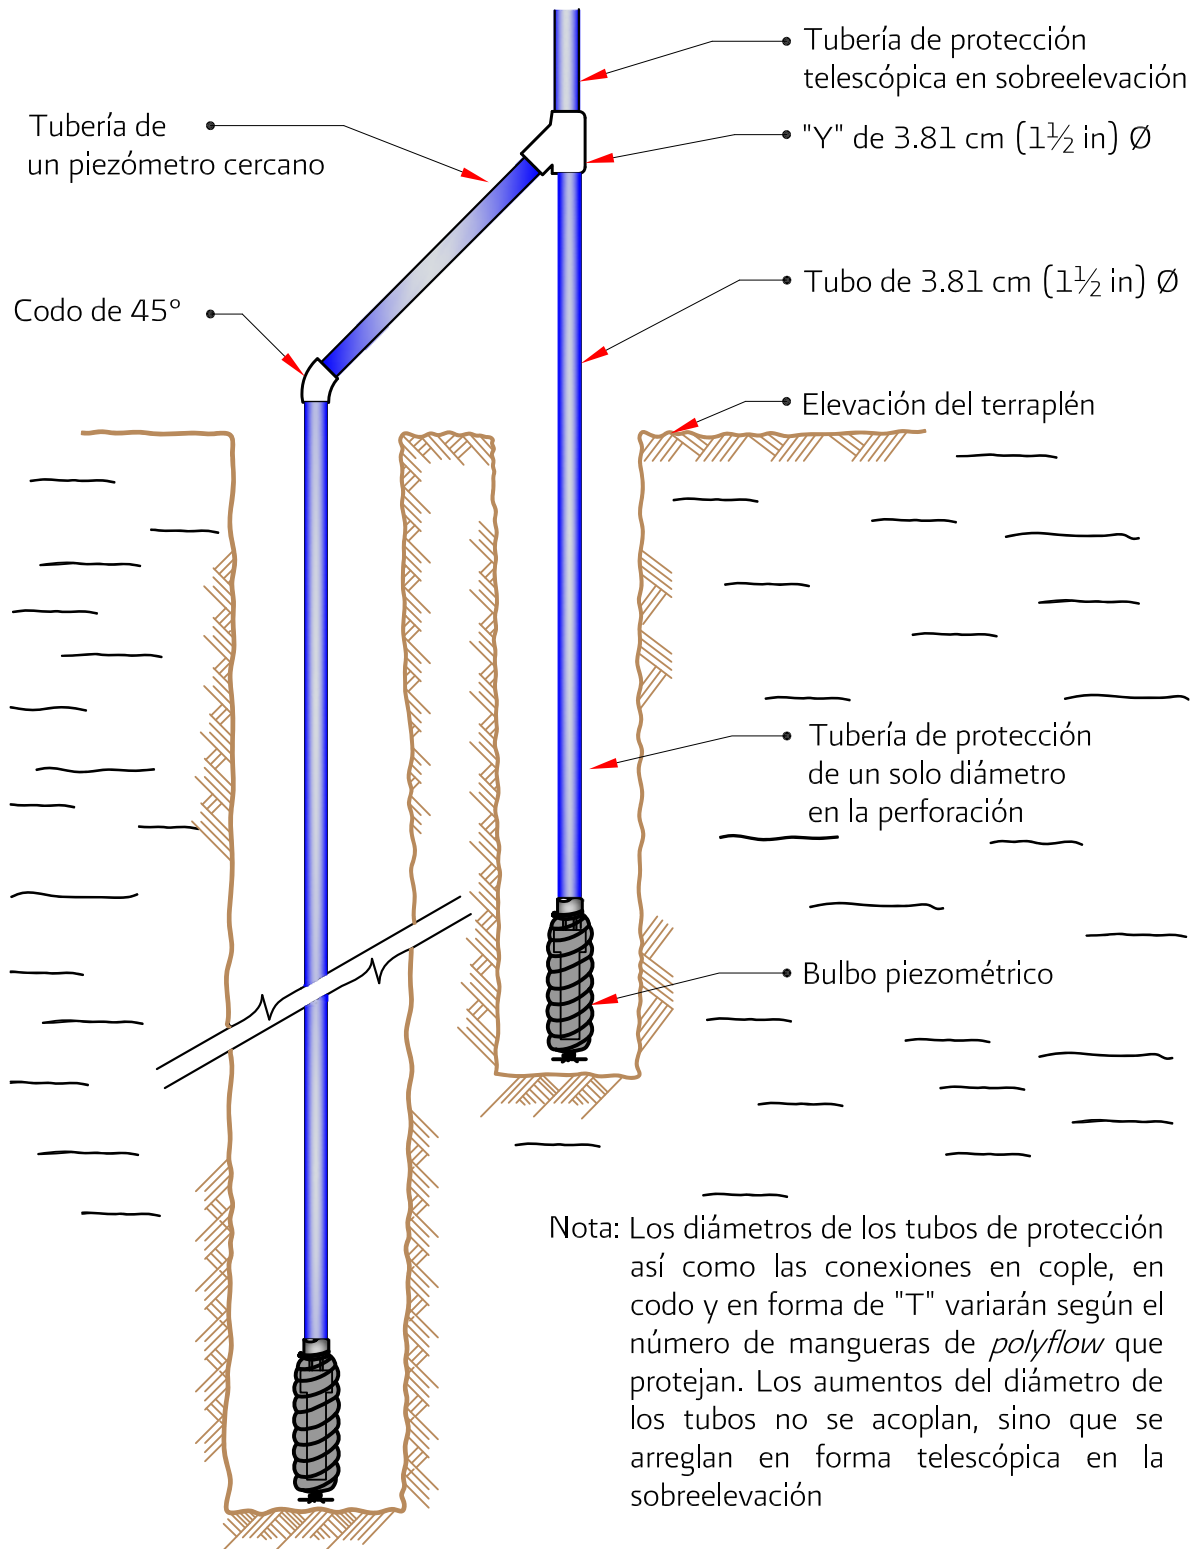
Arreglo de tuberías verticales para proteger las mangueras de los piezómetros neumáticos instalados en batería a diferentes elevaciones
